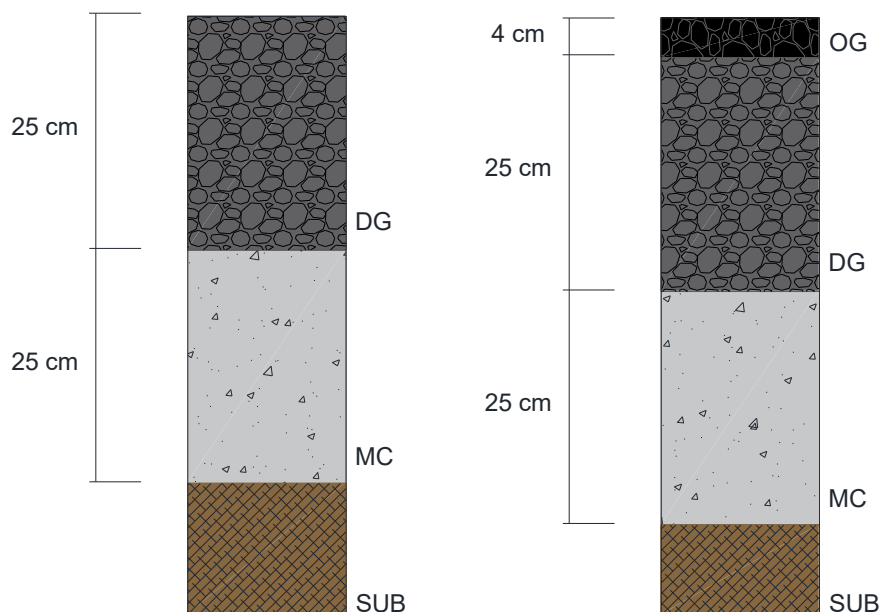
Stratigrafia delle pavimentazioni autostradali. A destra, con strato di usura drenante
